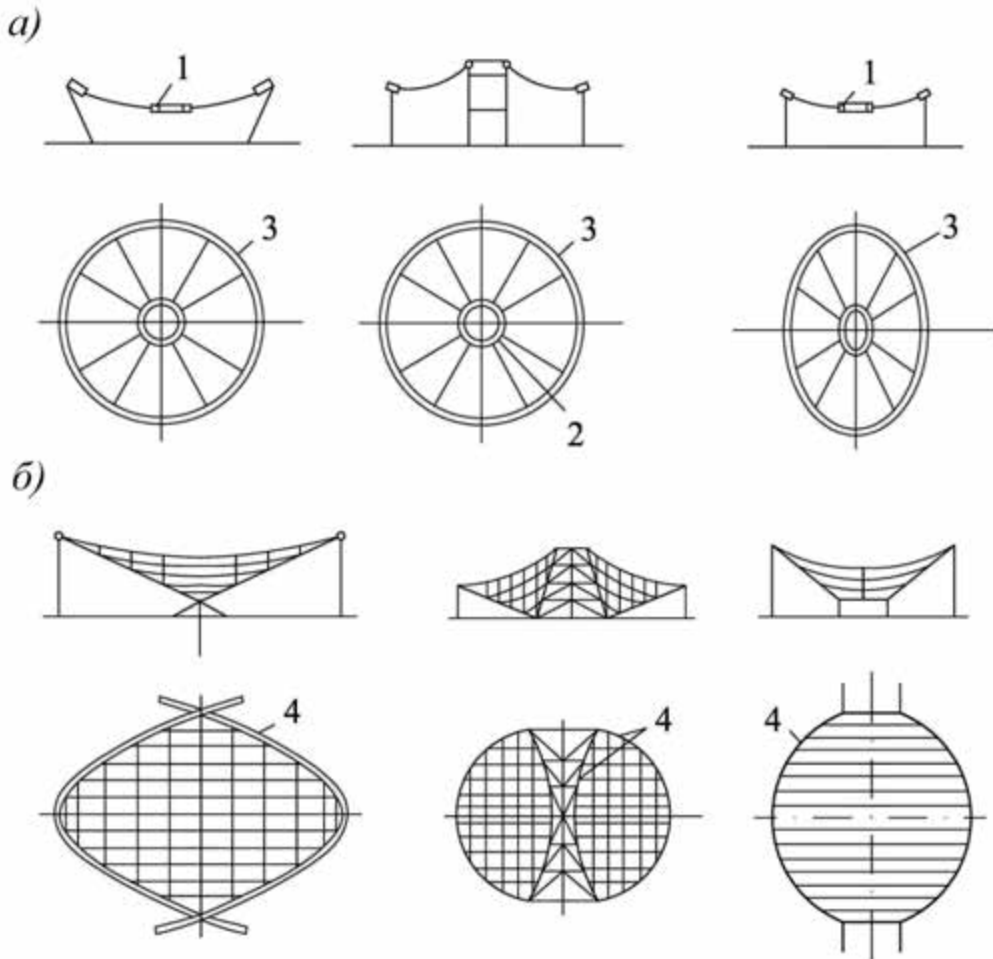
Схеми круглих та аровних опорних конструкцій:
